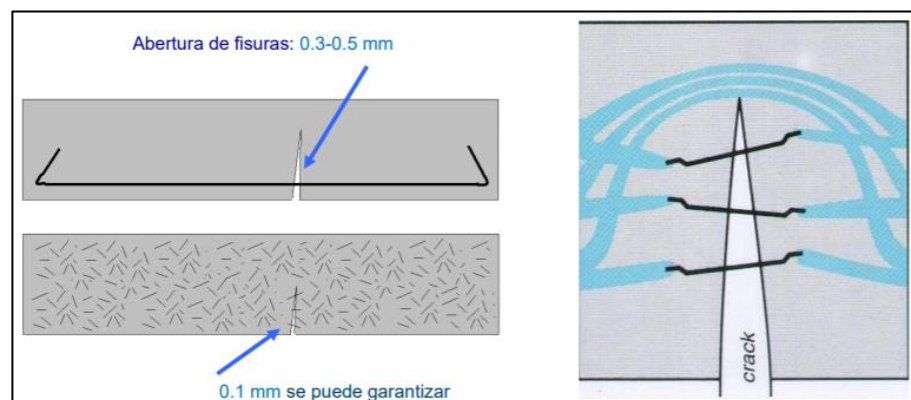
Mecanismo de control de propagación de las fisuras
